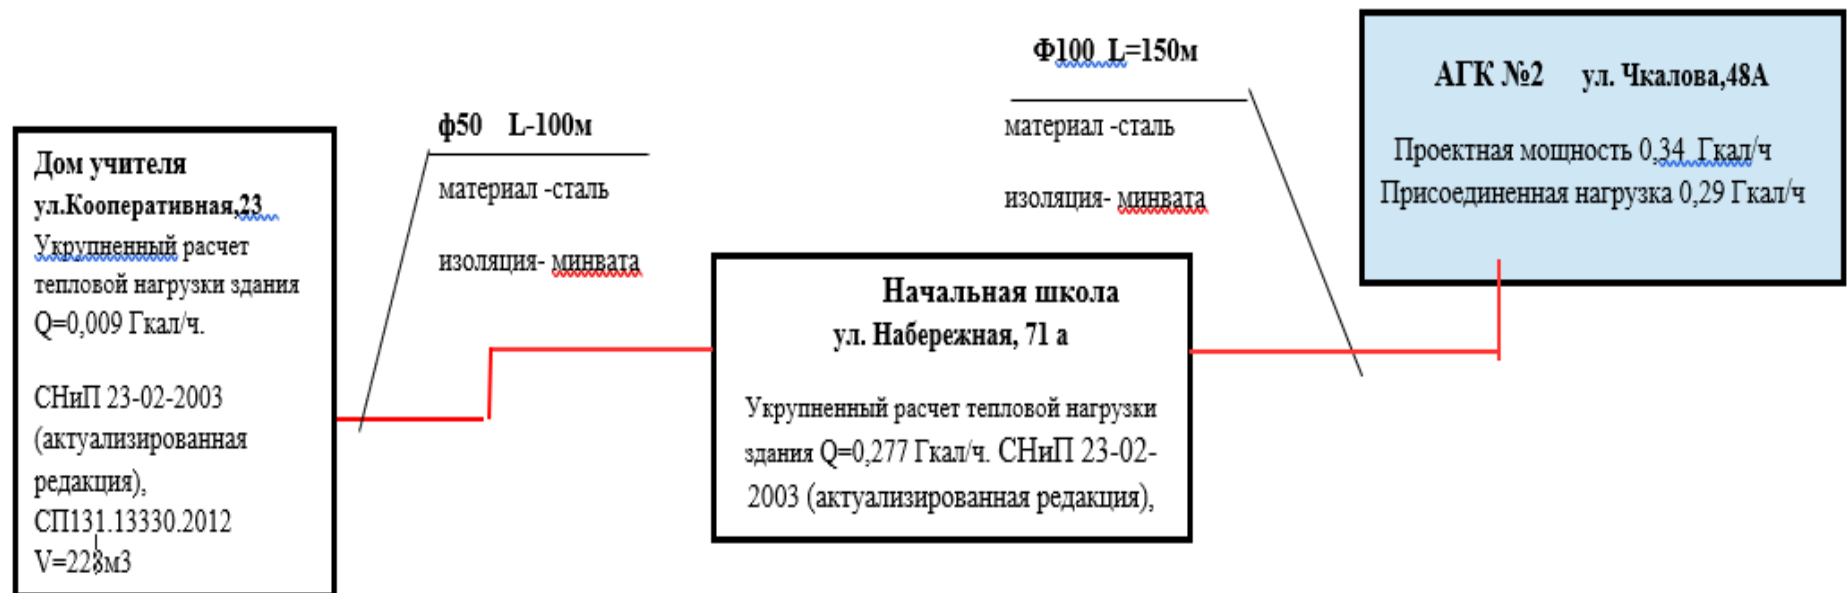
Схемы тепловых сетей от АГК №2 до начальной школы с. Подstepки
